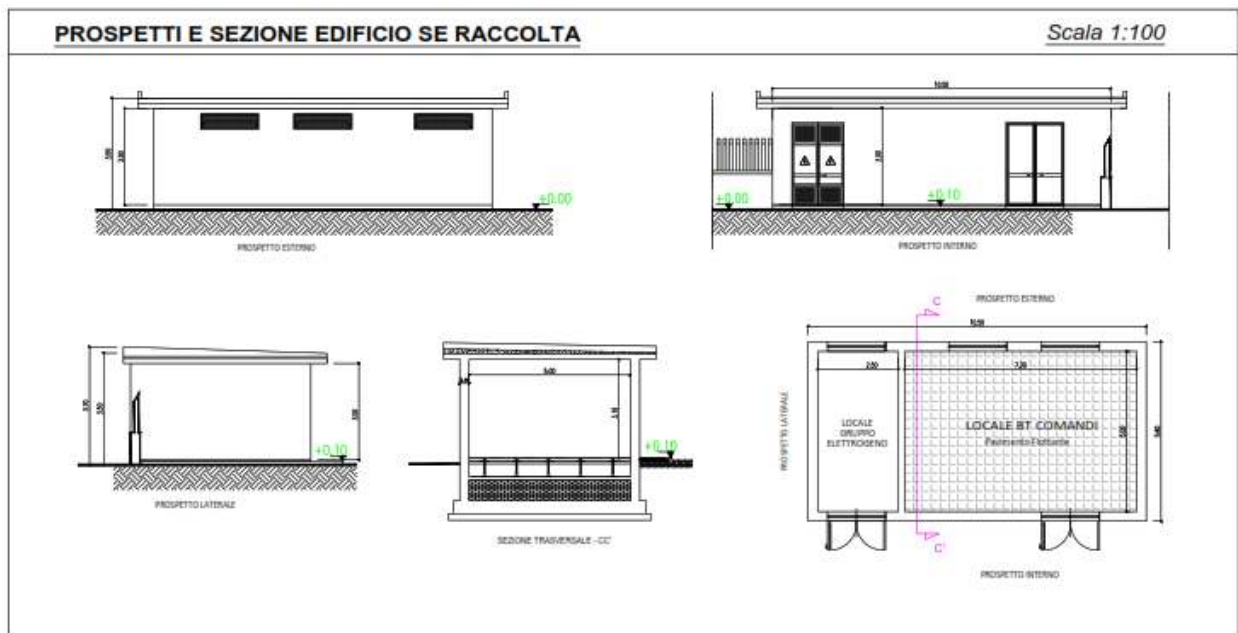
Estratto prospetti e sezioni planimetria sottostazione utente (area comune)
